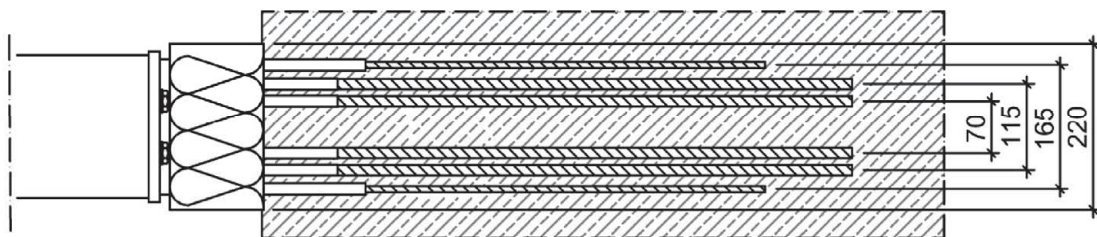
Grundriss IP 120 SM14 QQ
